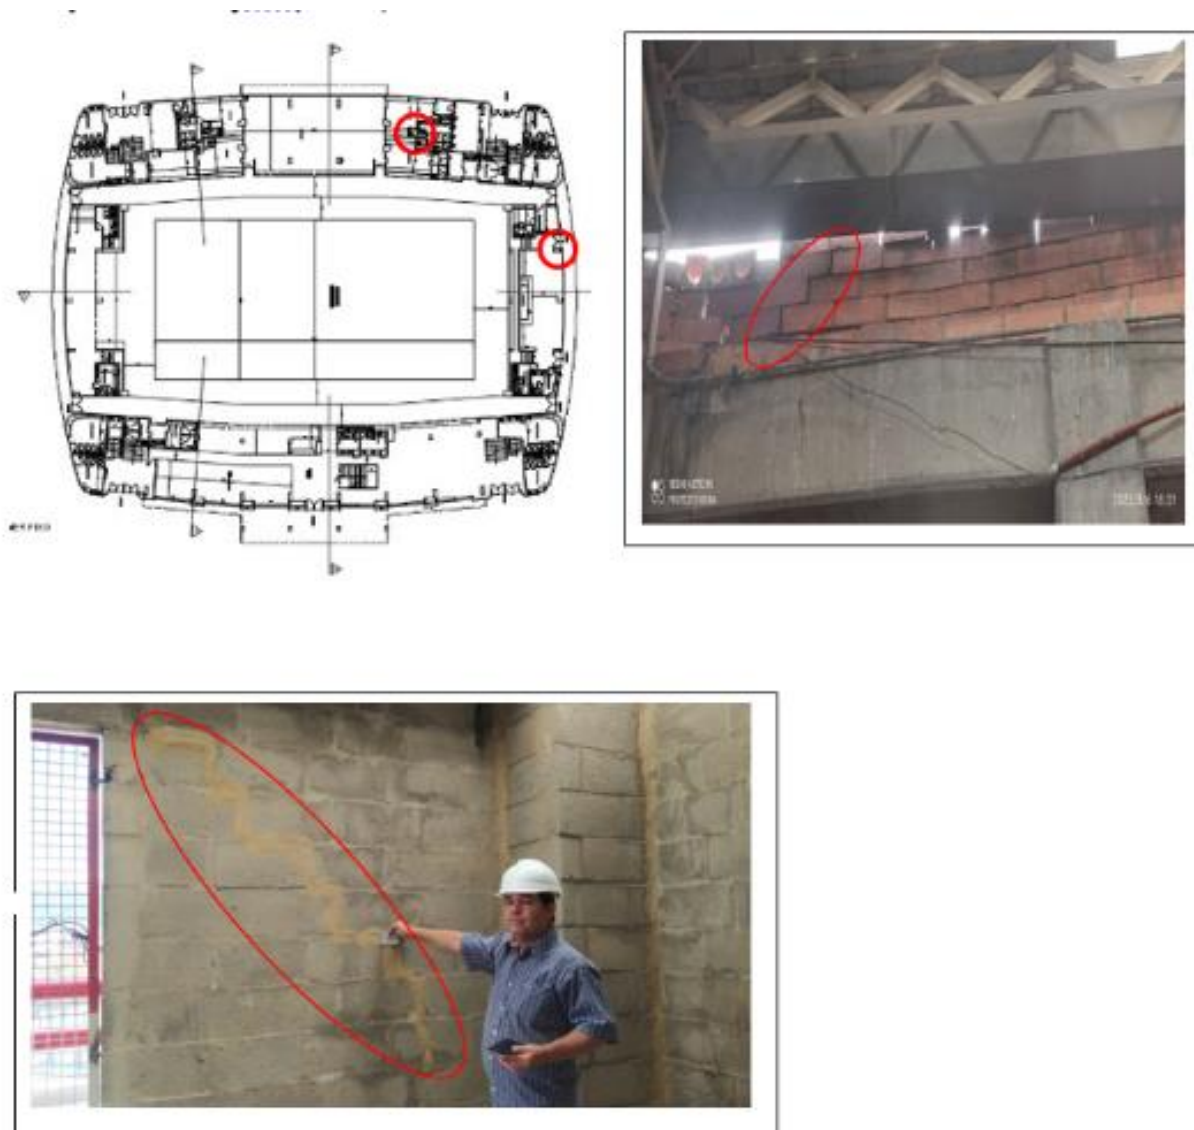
Grietas por cortante en mampostería en 2,3 pisos.
